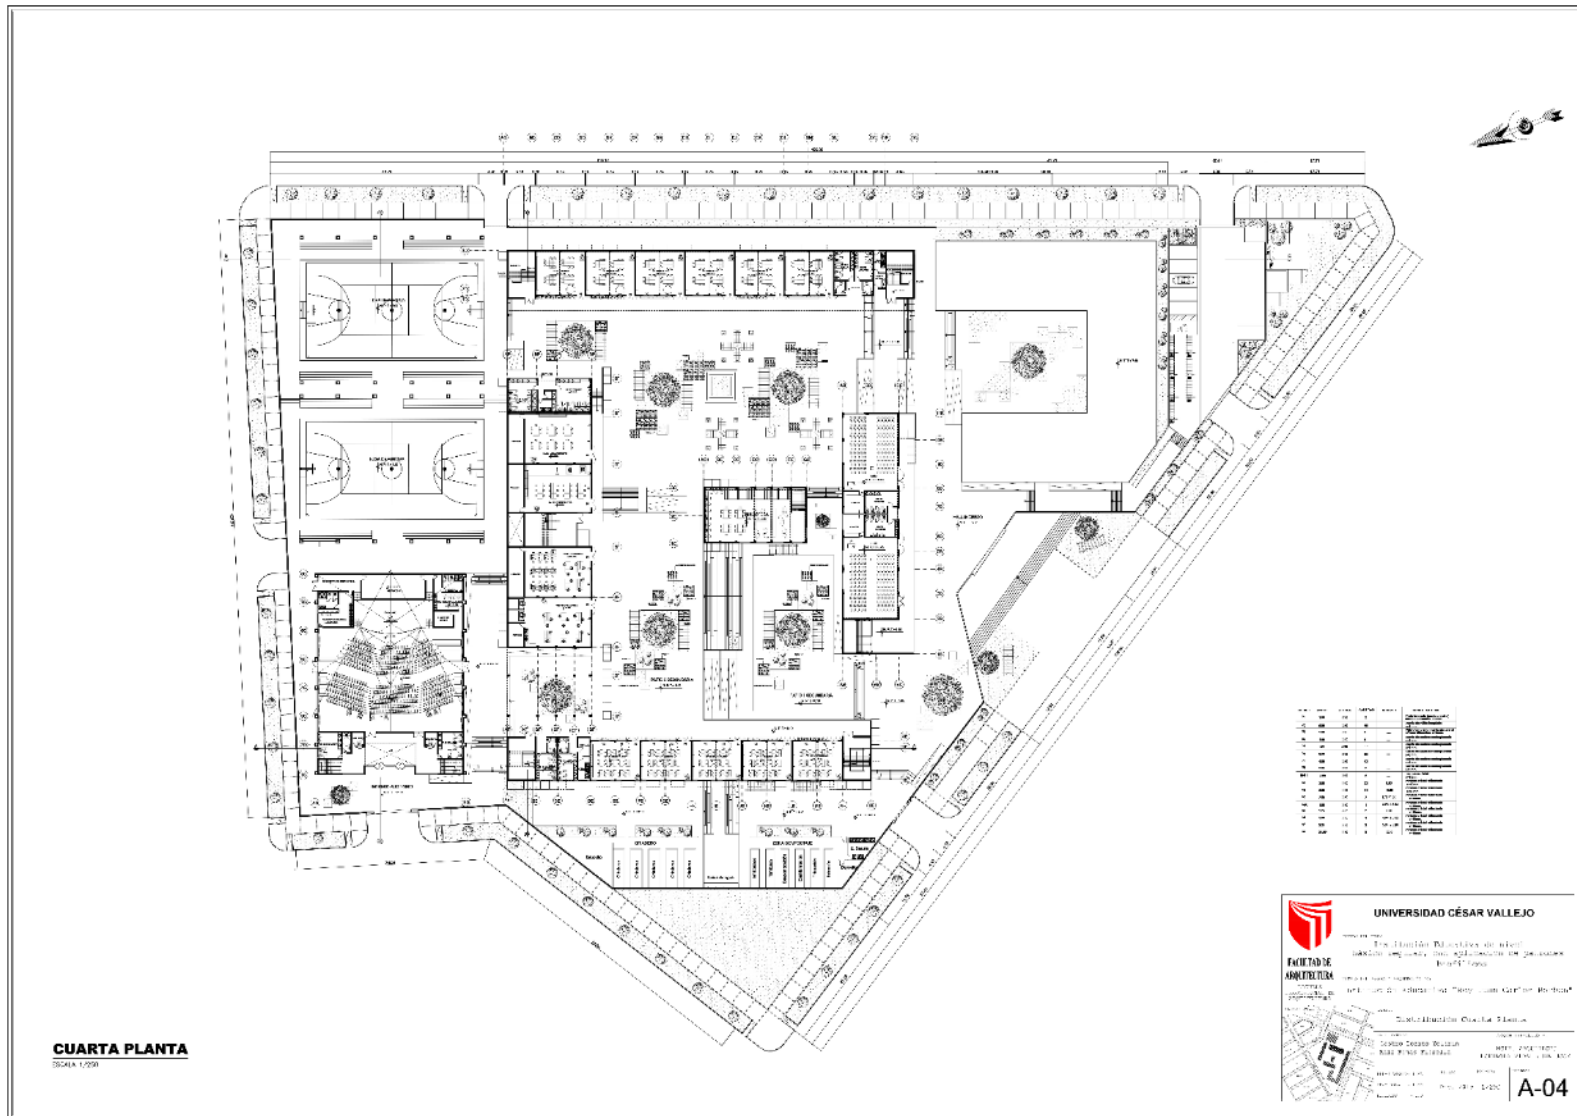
Plano cuarta planta, Fuente: elaboración propia
